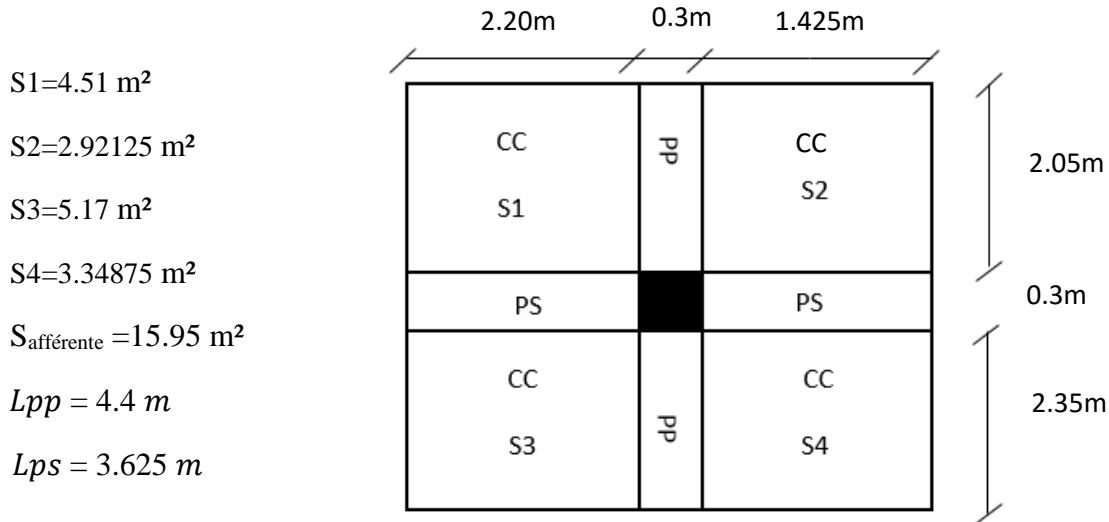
Surface afférente au niveau du plancher terrasse inaccessible.
